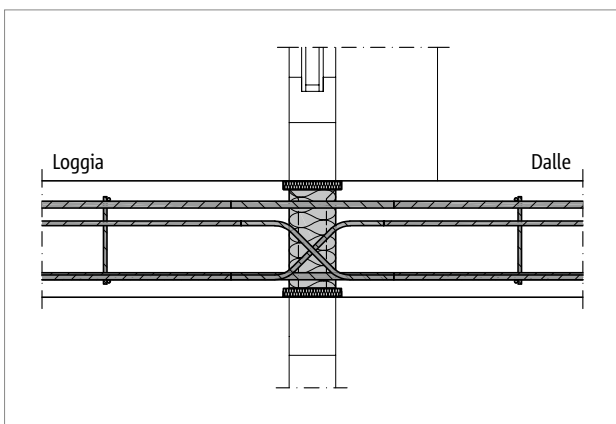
Schöck Rutherma® T type D : coupe de principe ; dalle portée sur deux appuis
